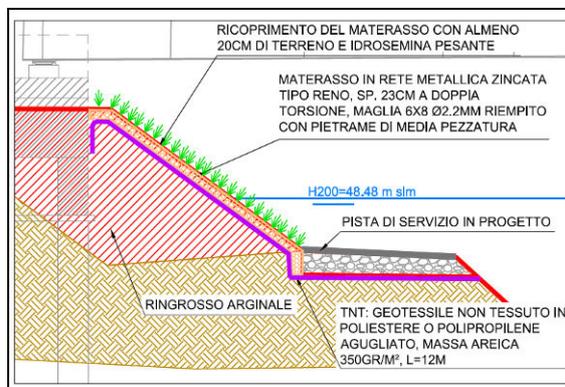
Particolare della sistemazione idraulica prevista sotto l'ombra del ponte
